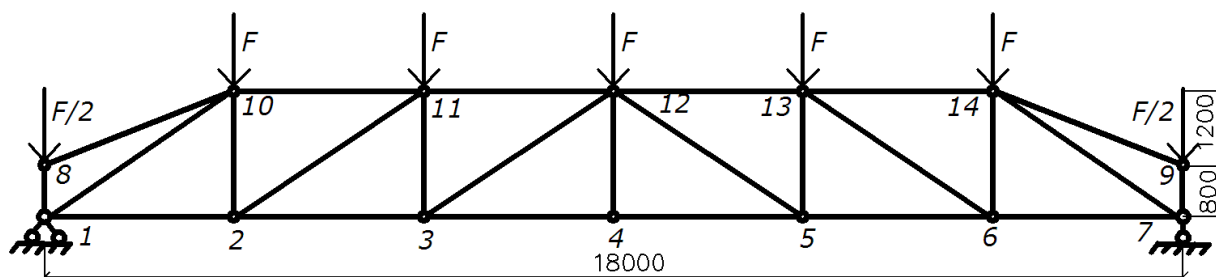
Нумерация узлов, распространяющаяся на все варианты ферм (в треугольной ферме 4 стержня отсутствуют)
